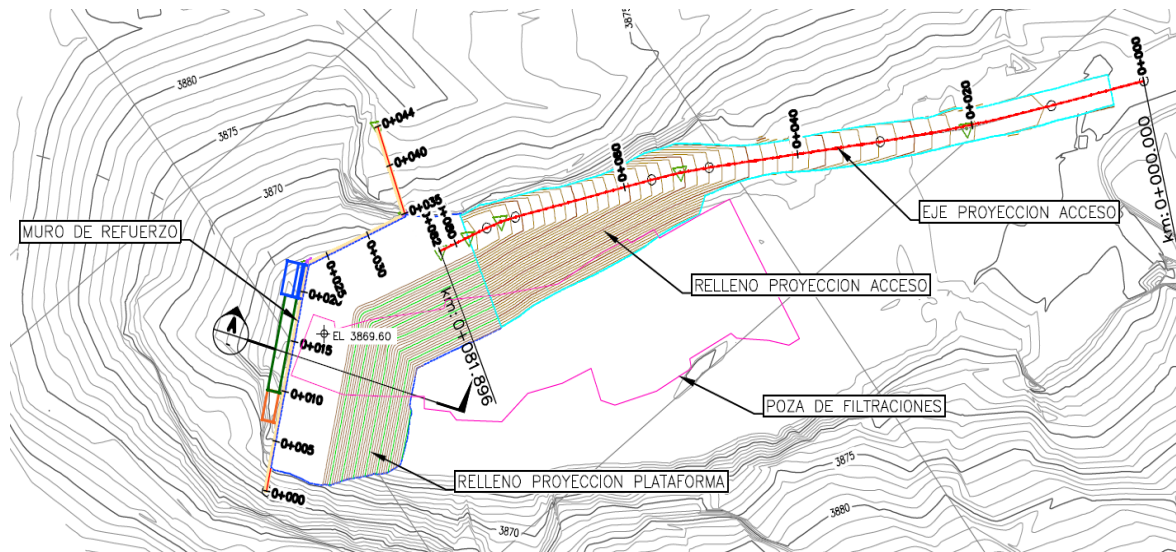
Planeamento para a construção do aterro provisório e rampa de acesso.
